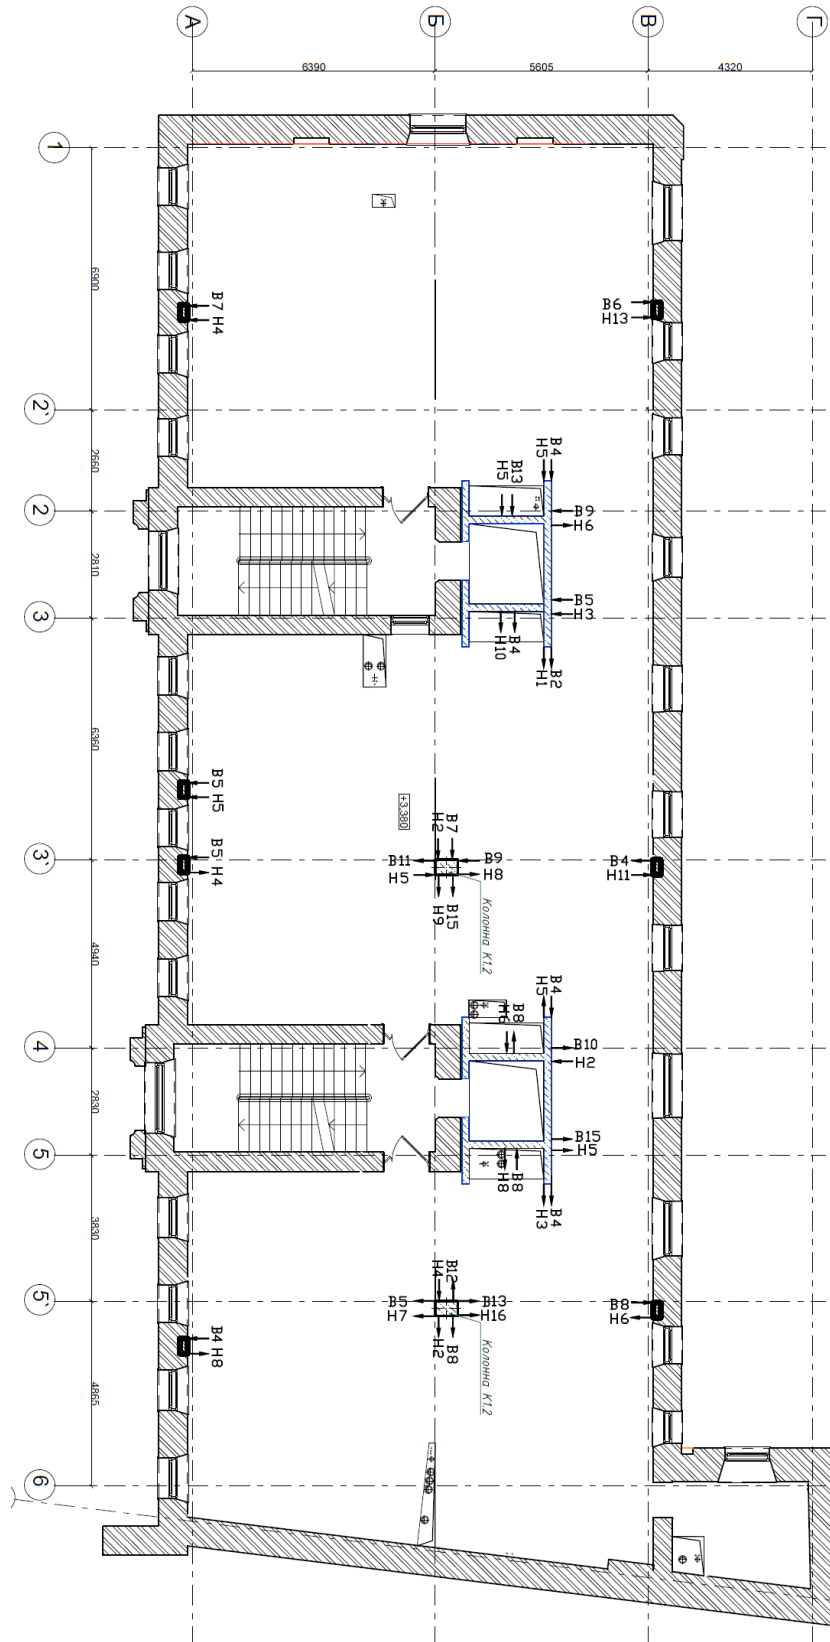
Фрагмент геодезической съемки 2-го этажа с отклонениями, в мм
